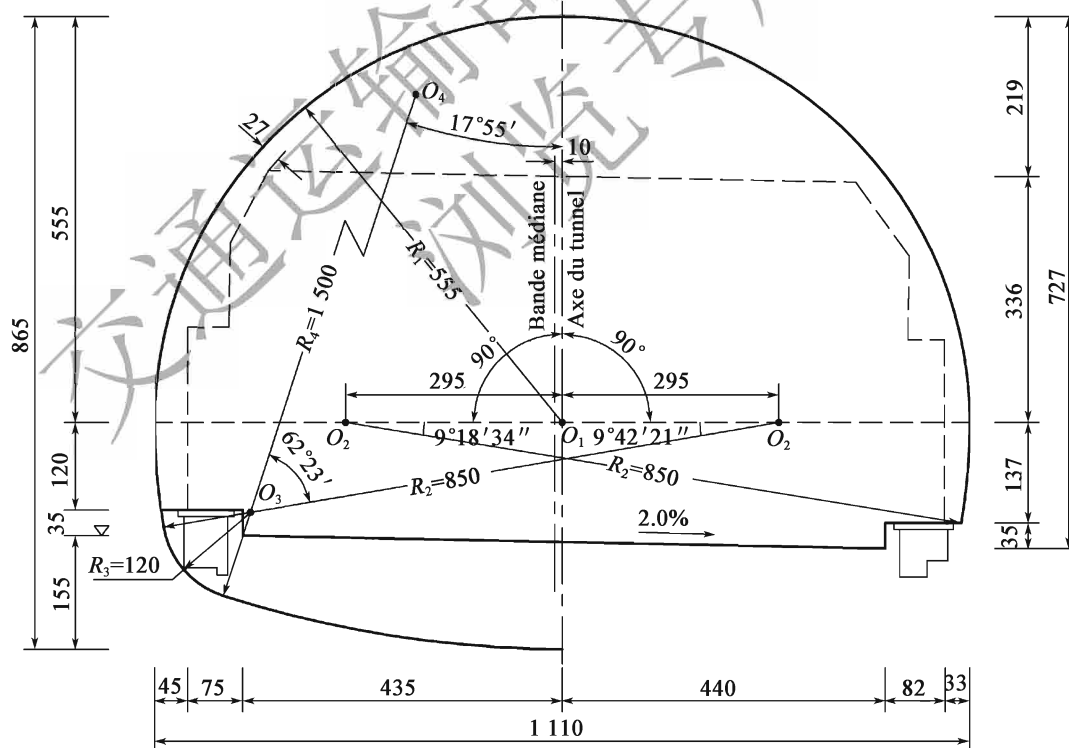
Gabarit du tunnel autoroutier et du tunnel routier de première classe à deux voies(80km/h) (unité:cm)
